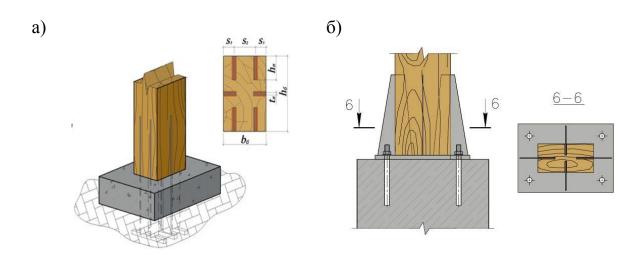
Узел сопряжения колонны с фундаментом каркасного здания в Ванкувере.
